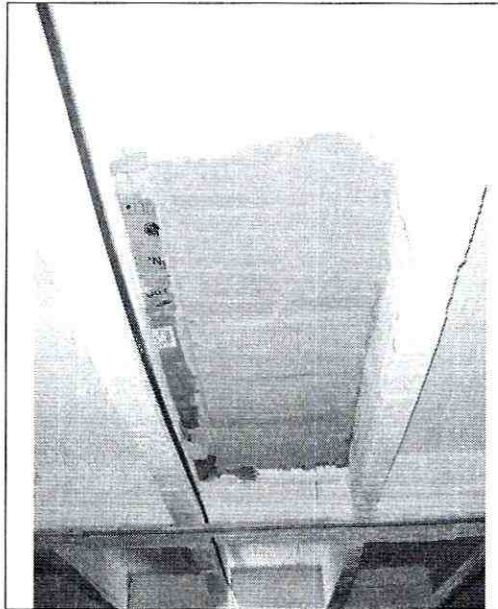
Parche en concreto realizado en la cara inferior de una loseta del entripiso.
